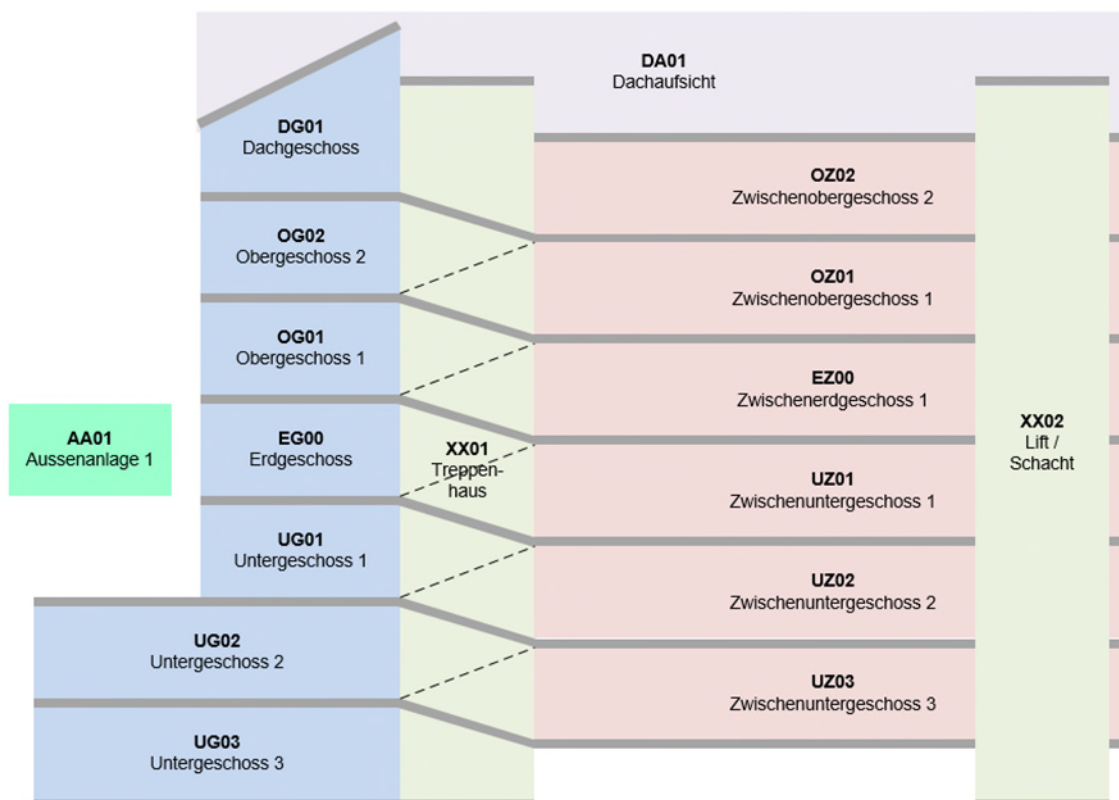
Bezeichnung Geschoss-, Treppenhaus/Schacht und Aussenanlage
